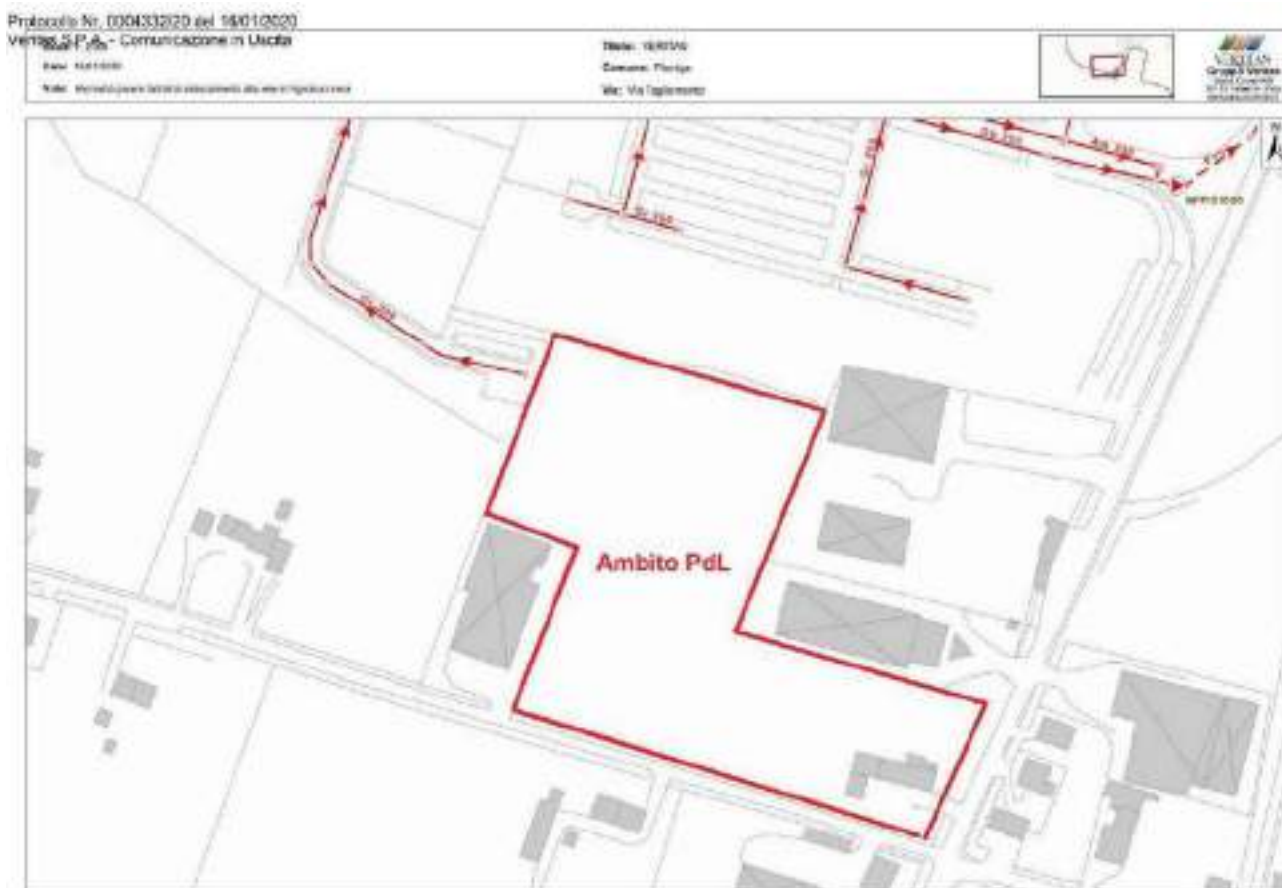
/2: Planimetria rete fognaria esistente e ambito oggetto di PdL (in rosso)
